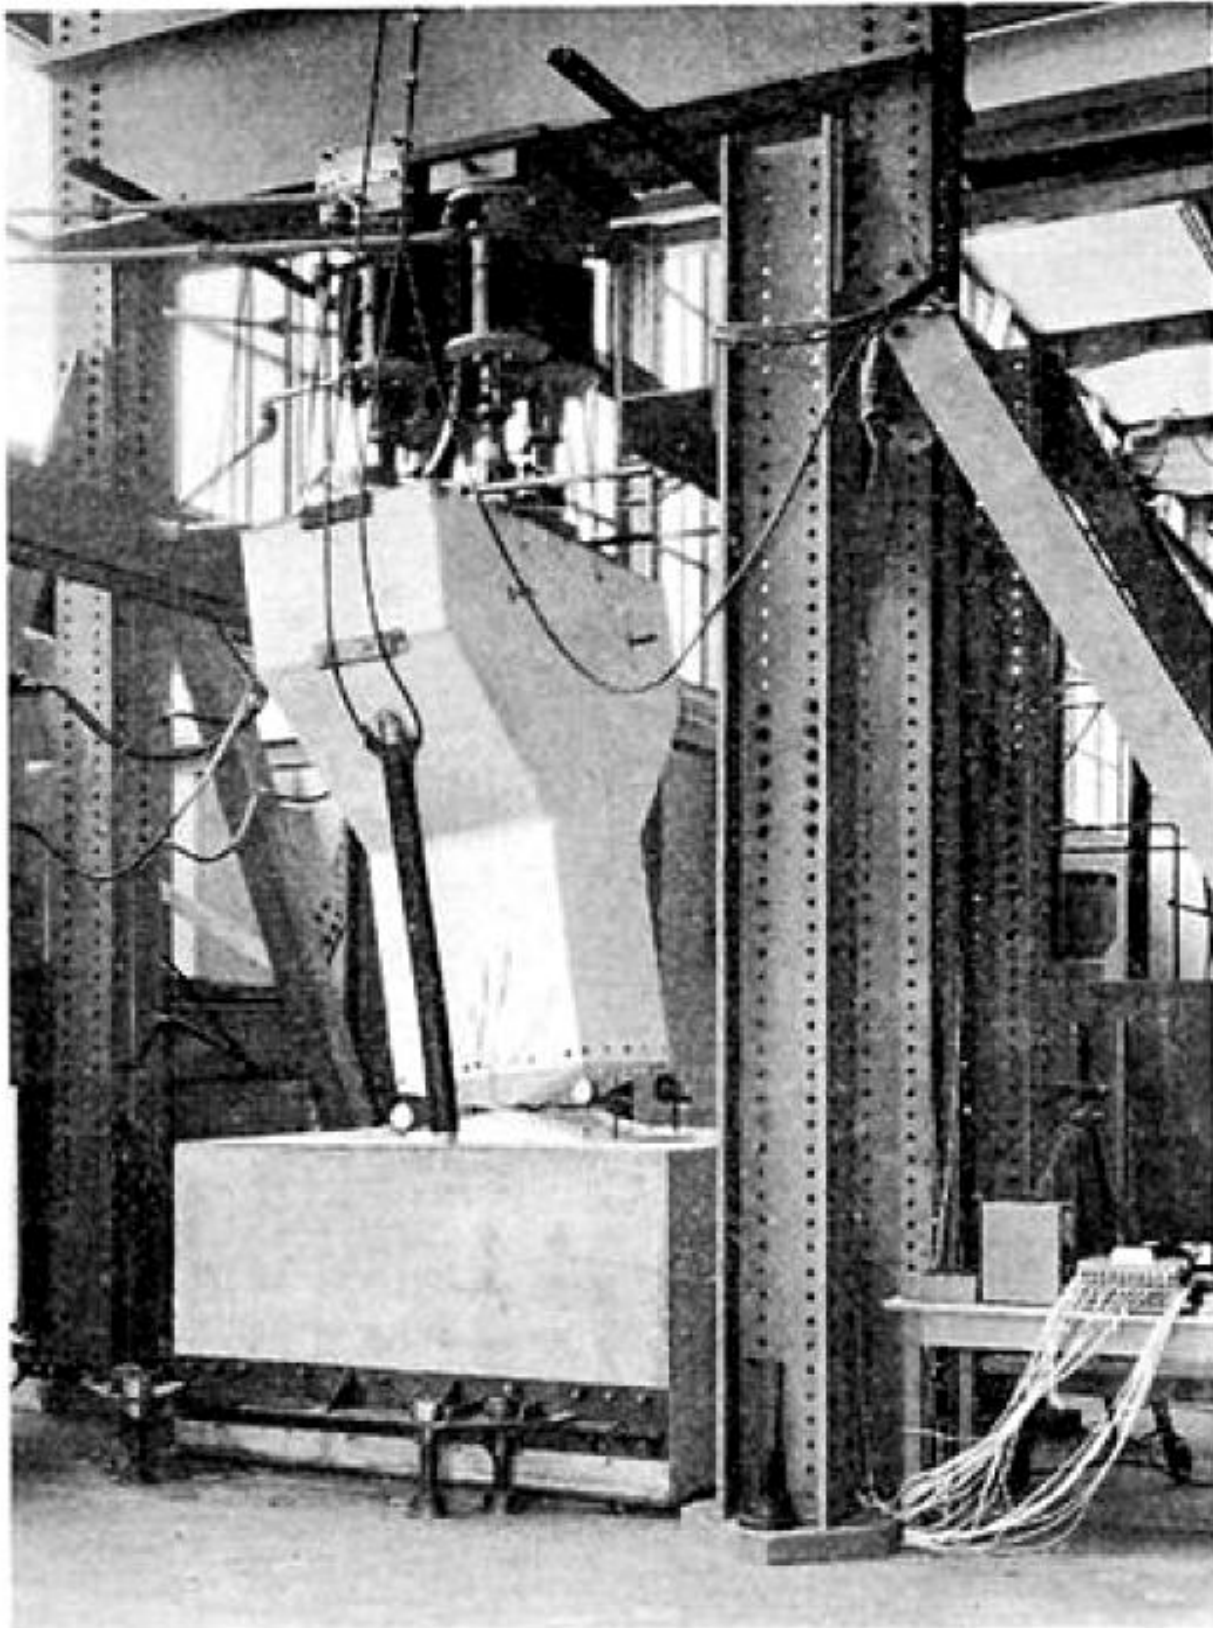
Erprobung eines Betonfederglenkes für eine Eisenbahnbrücke. Unter statischer Belastung entsprechend dem Eigengewicht der Brücke Auslenkung bis 14 %.
